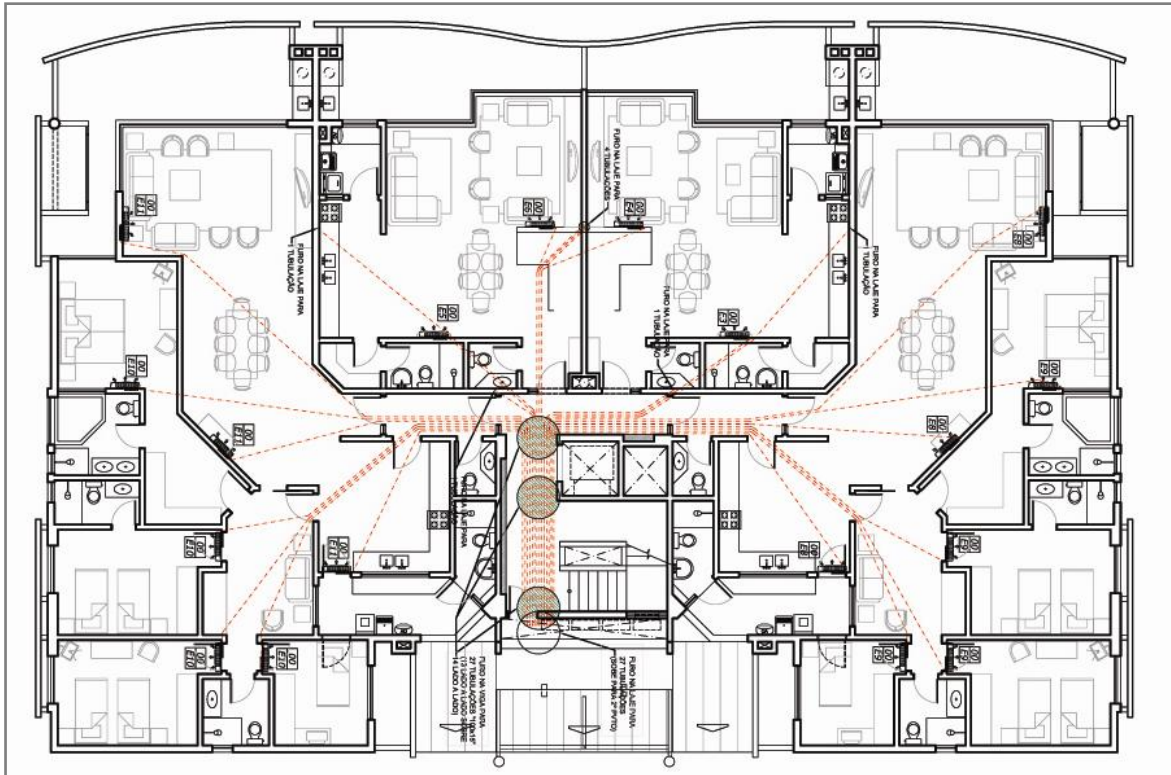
Planta baixa do projeto de ar-condicionado do pavimento tipo do bloco 02.
